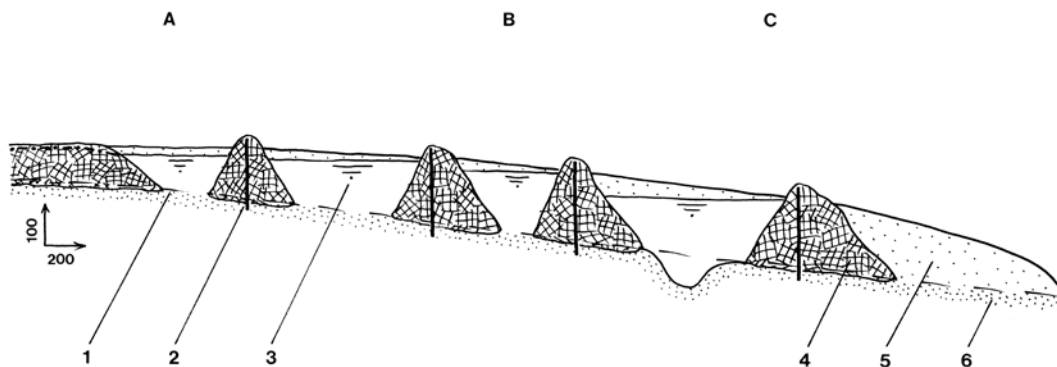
Illustration des différents objectifs de gestion par barrage des drains, en relation avec la pente du terrain: coupe transversale; dimensions en cm; restauration (A), réhumidification (B) ou diversification (C); 1: fond de la rigole; 2: barrage; 3: mare; 4: tourbe tassée; 5: tourbe dégradée; 6: tourbe intacte
